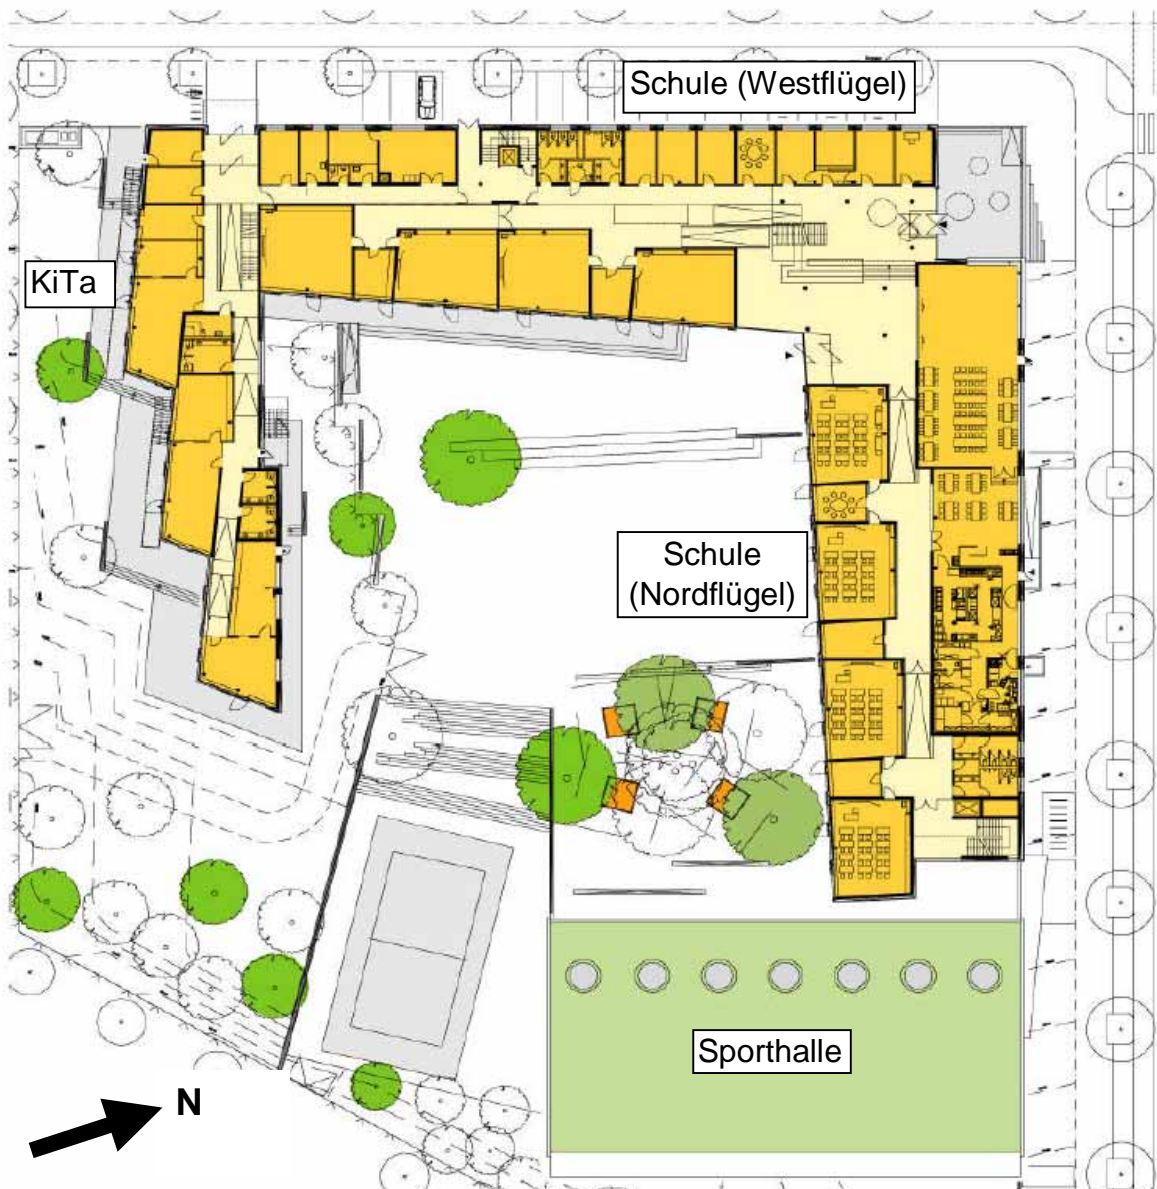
Grundriss EG von Schule, KiTa und Sporthalle (Quelle: Architekturbüro 4a)
